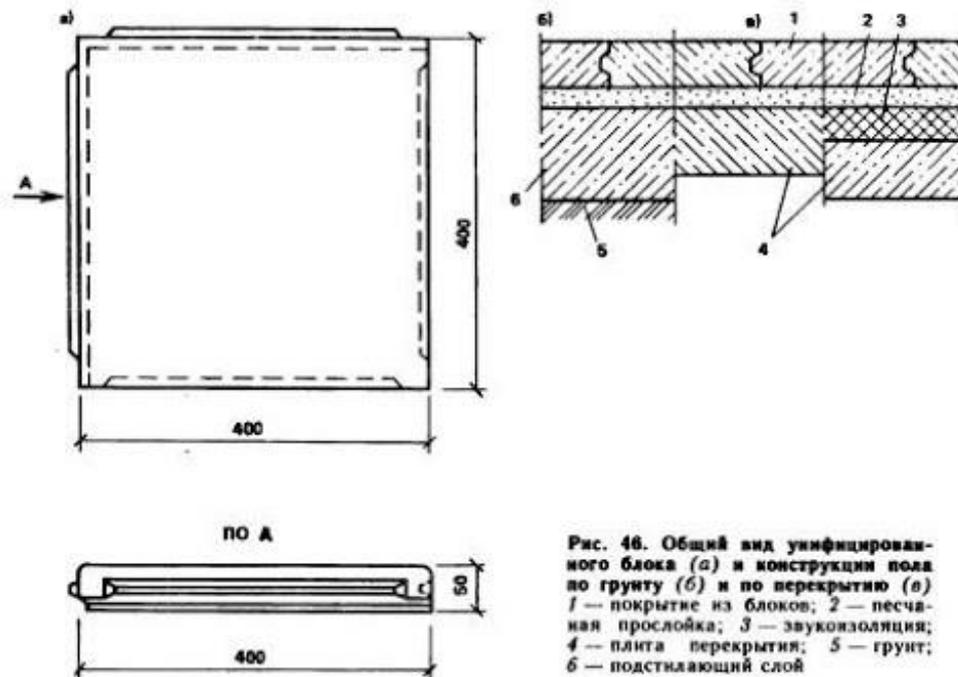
Общий вид унифицированного блока (а) и конструкции пола по грунту (б) и по перекрытию (в)
